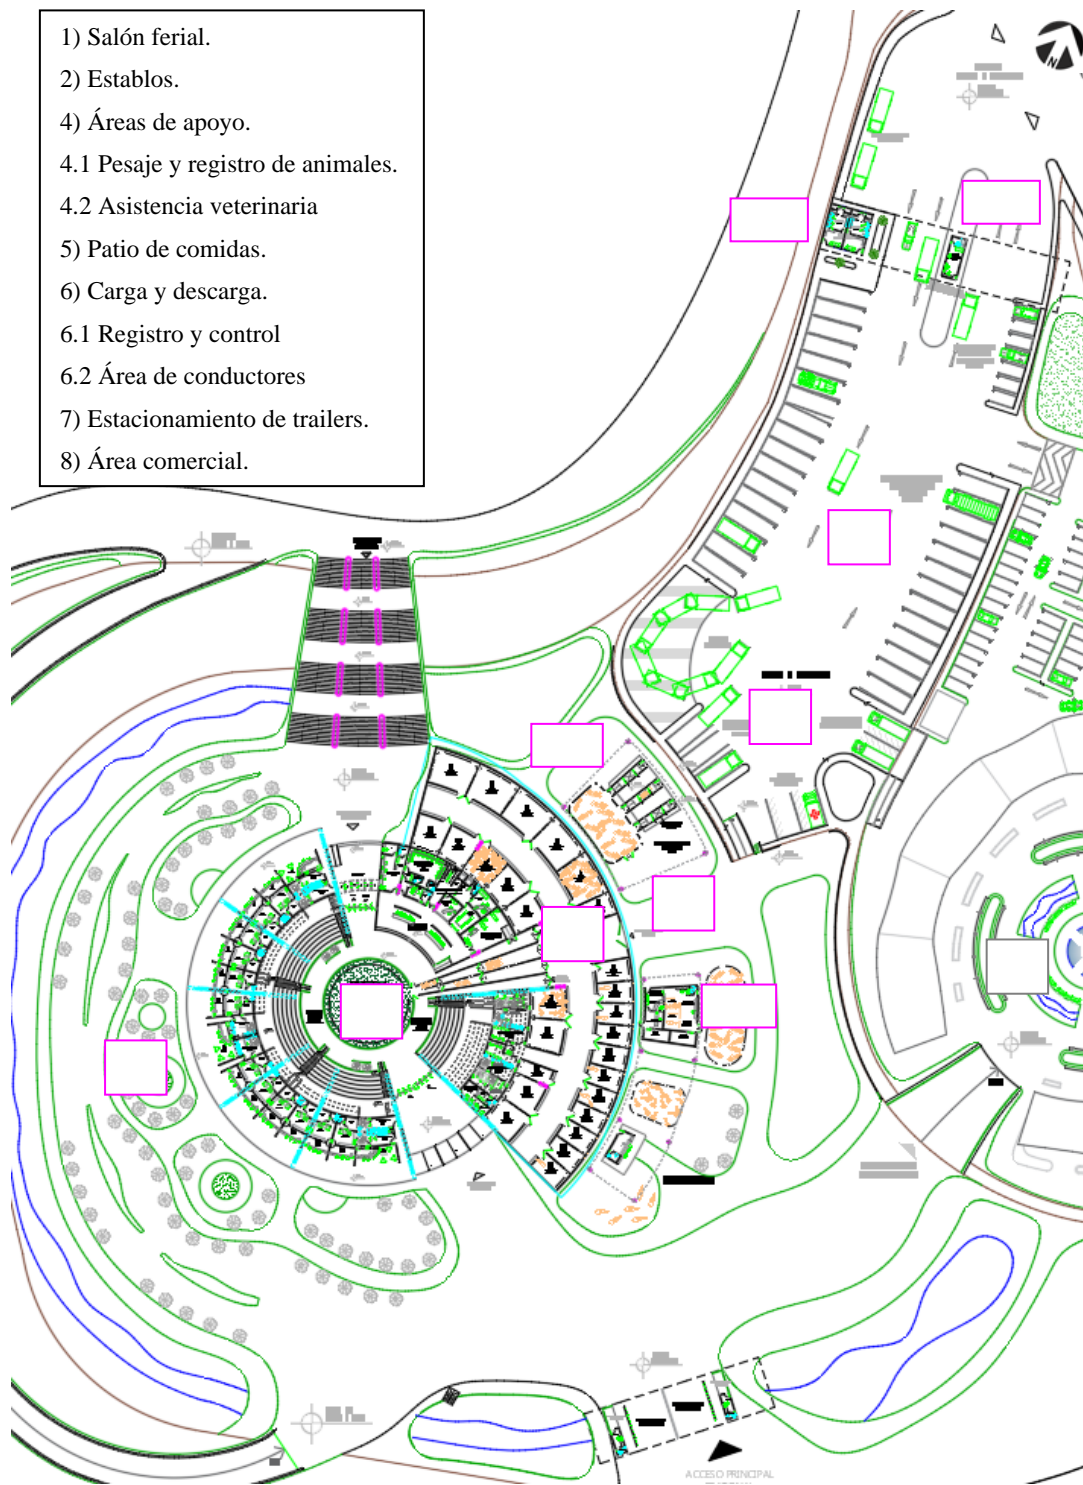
Planta baja conjunto del salón ferial. La Autora (2020)
